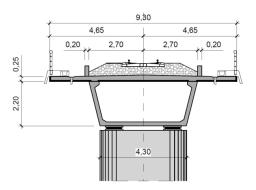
Sección Tipo Tablero Viaducto del Bagastrá
